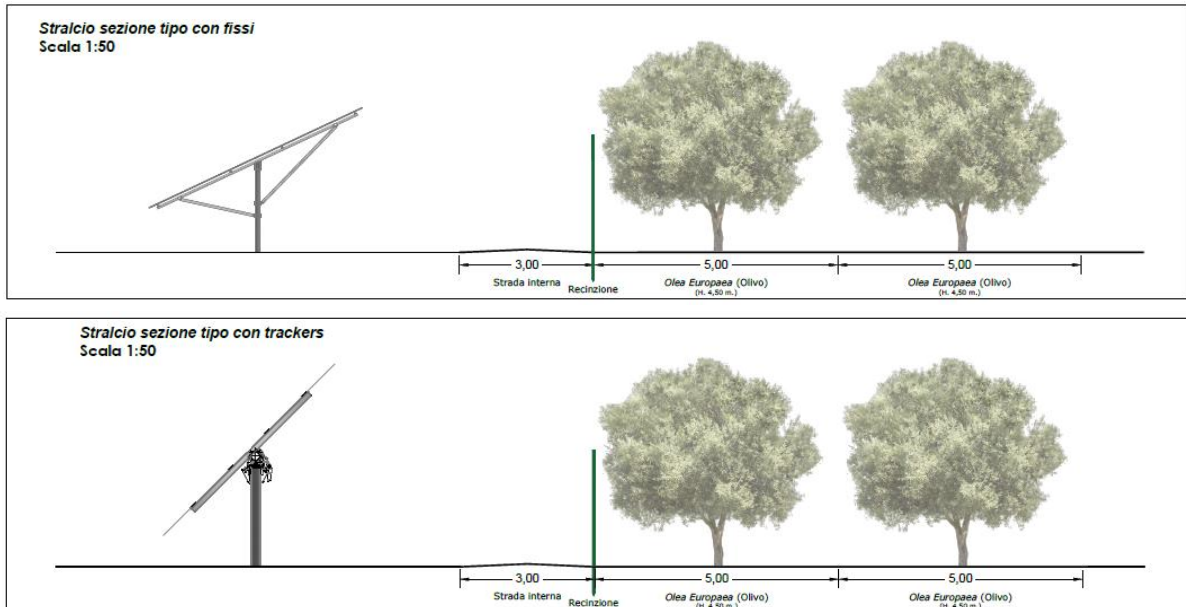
Stralcio sezioni tipo su fissi e su trackers fascia di mitigazione
